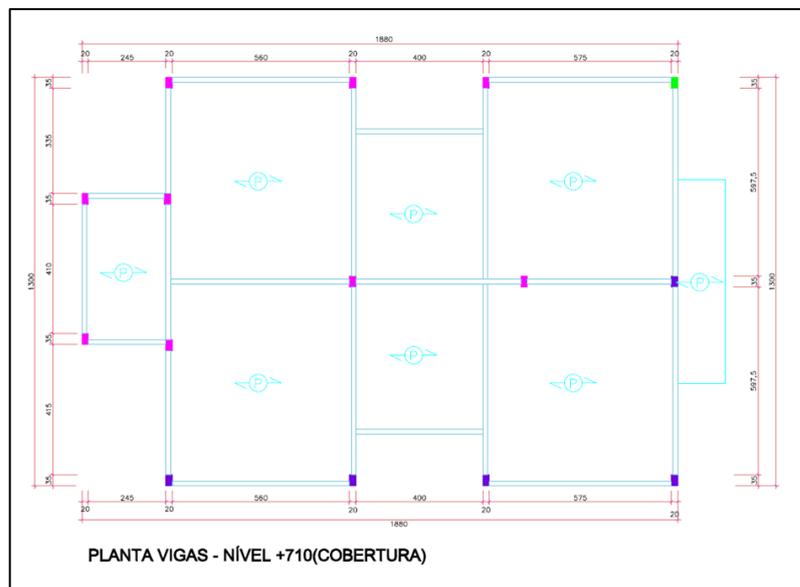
Projeto estrutural 01: Nível +7,10 m
